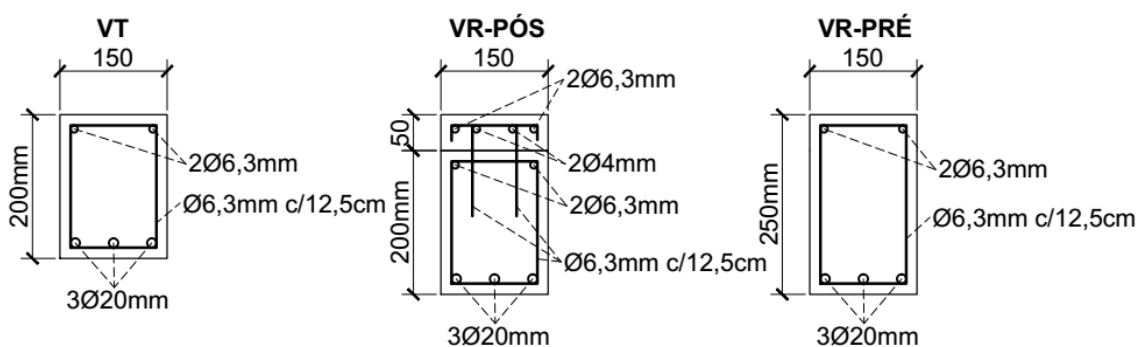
Detalhamento das vigas (ANDO *et al.*, 2012).
